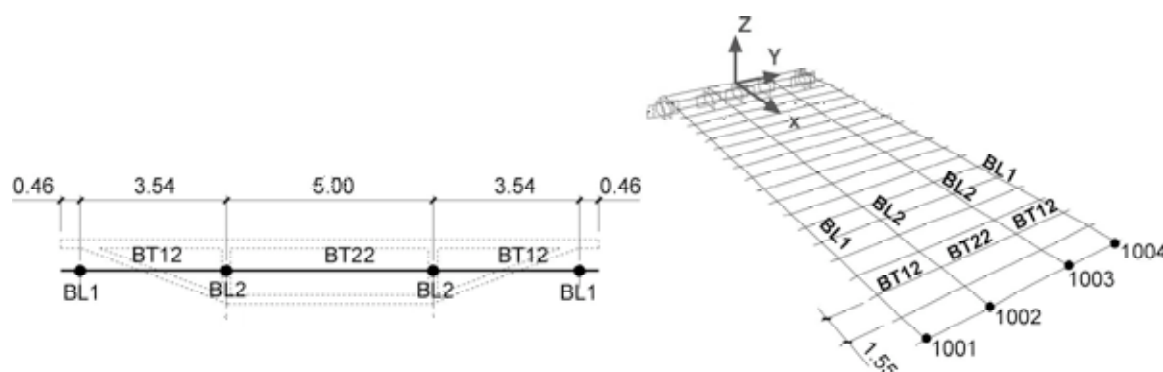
Modelos de Emparrillado Plano. Disposición de barras y nudos de referencia.
